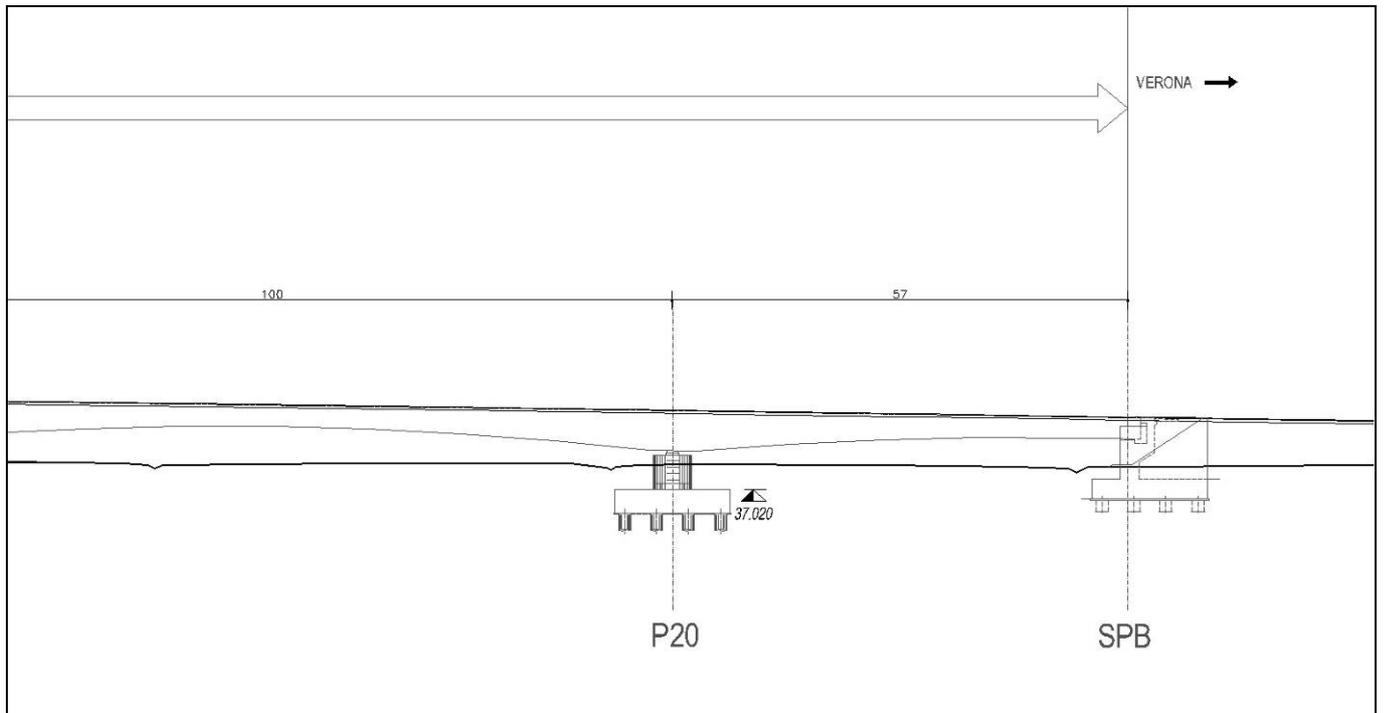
Profilo longitudinale del Progetto Definitivo del Ponte sul Fiume Taro nel tratto della spalle nord.
